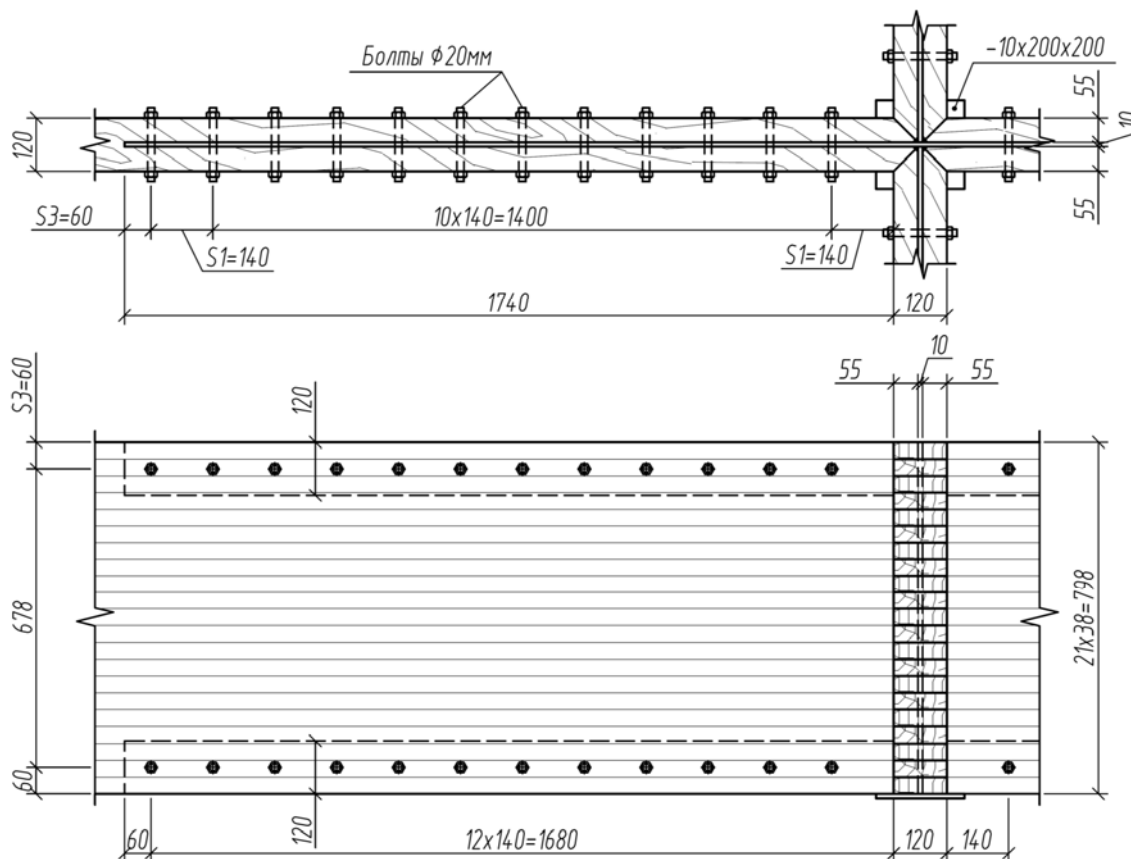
Конструкция узла сопряжения балок по варианту №3 (тип А)
